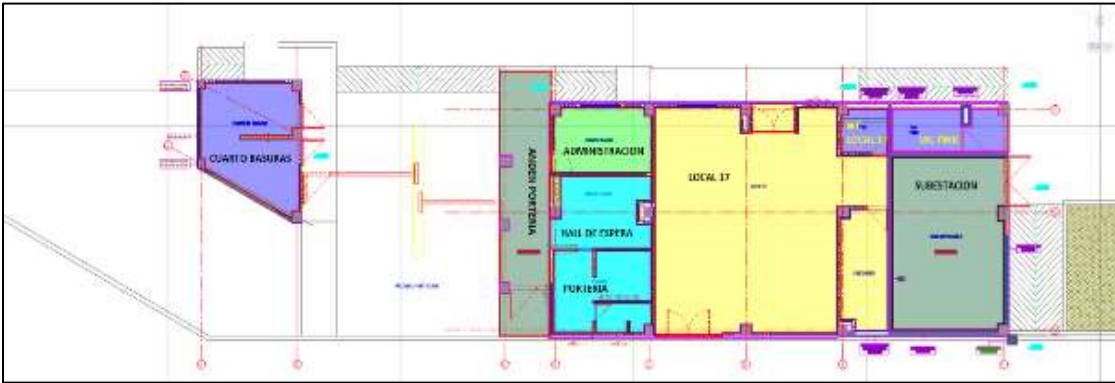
Totalizado correspondiente a Mampostería y Elementos No Estructurales
